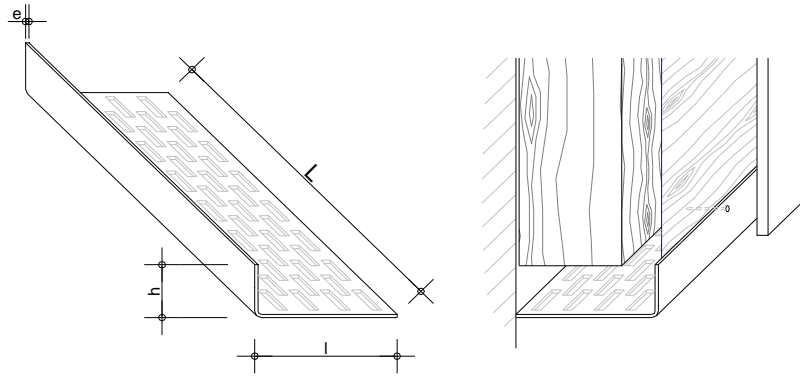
Profil de ventilation assurant aération des façades et protection basse
